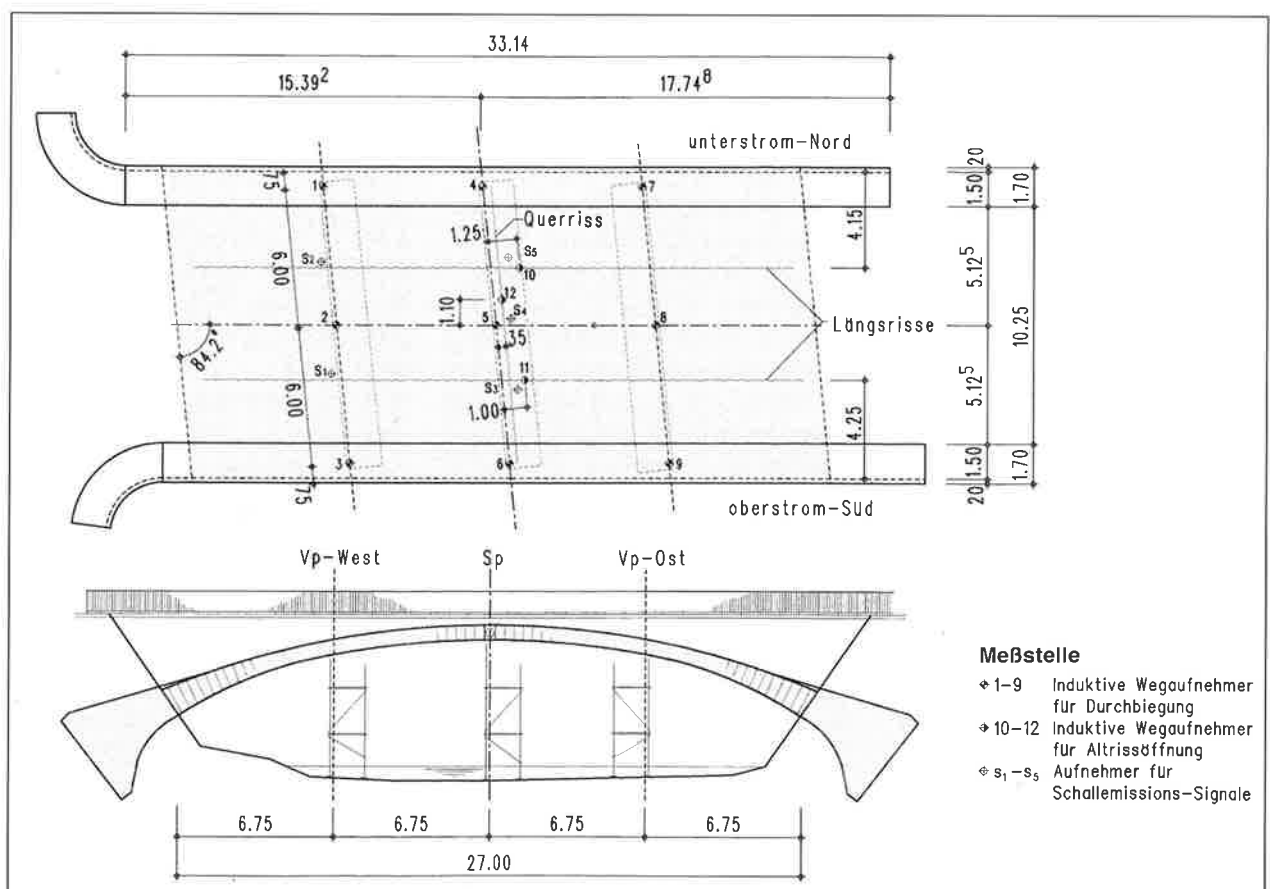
Grundriß (Meßstellenplan) und Ansicht der untersuchten Brücke mit Geometrieparametern
